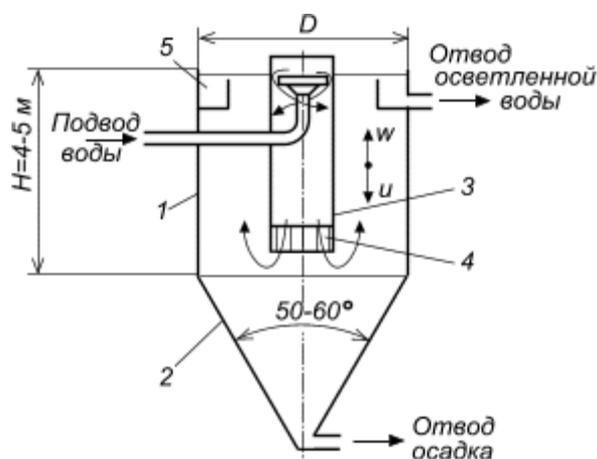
Вертикальный отстойник: 1 – корпус; 2 – накопитель; 3 – центральная цилиндрическая труба; 4 – гаситель завихрений; 5 – сборный желоб
